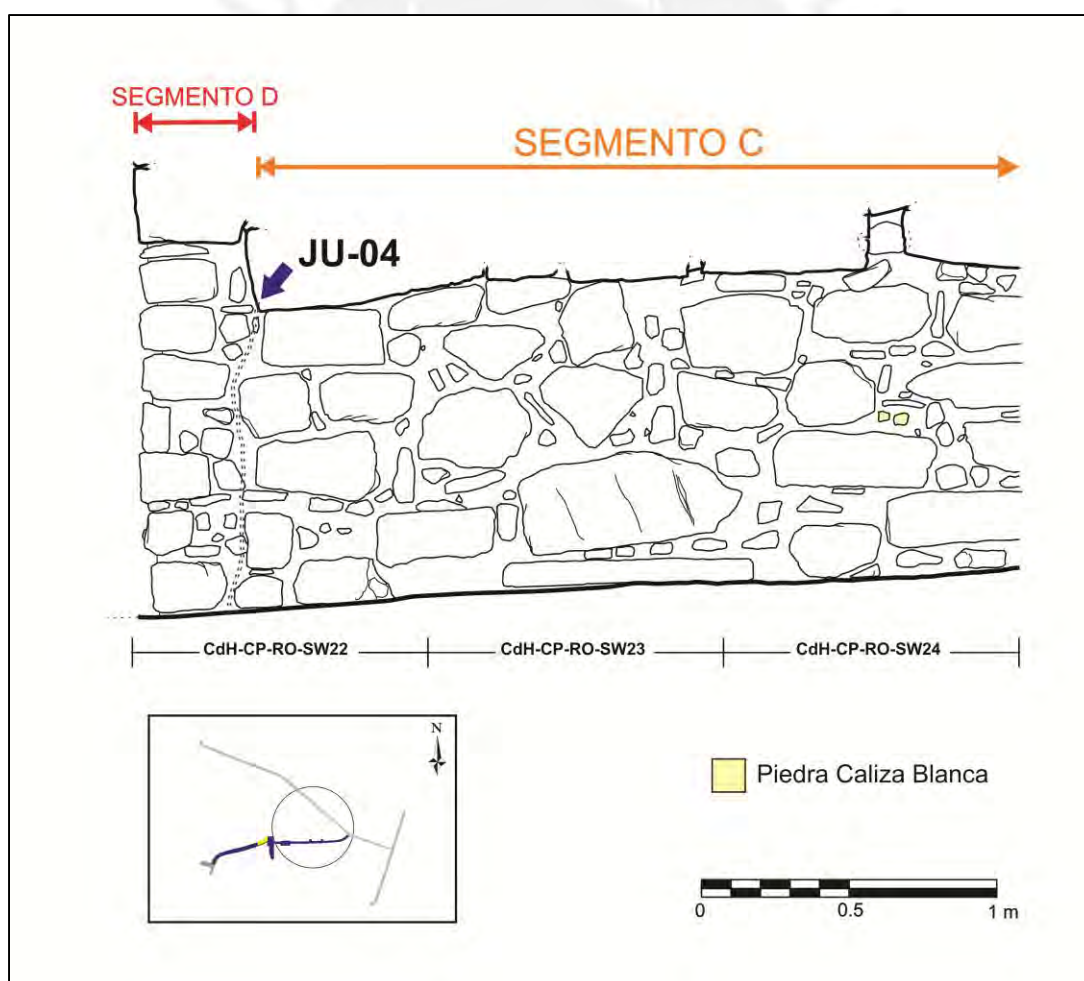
Dibujo frontal del extremo oriental de la pared RL.02-N. Detalle de la junta JU-04.
